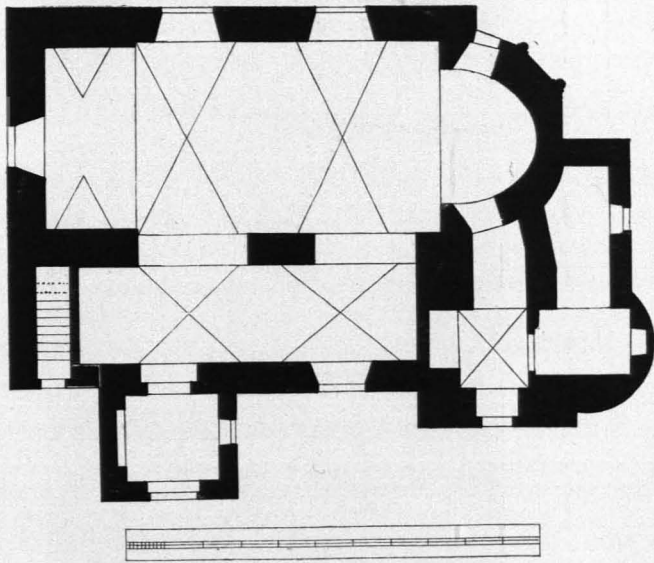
Kühnring, Pfarrkirche, Grundriß 1:250 (S. 90)
